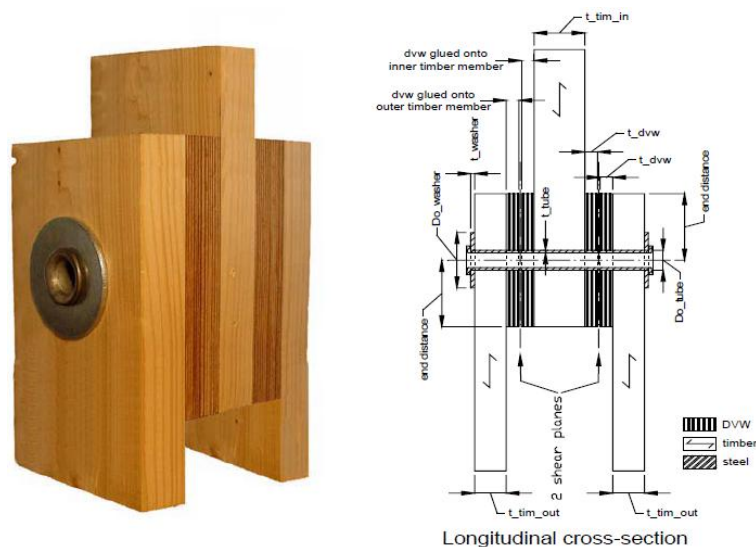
Fotografia e corte transversal da ligação DVW. (Kuilen e Dejong, 2004)
